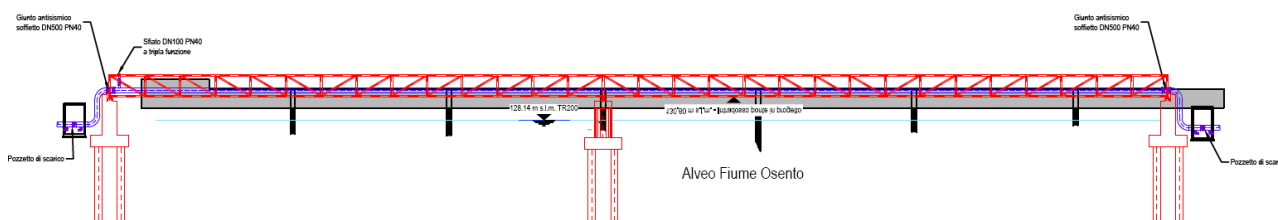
Sezione longitudinale attraversamento aereo di progetto sul Fiume Oseno.
